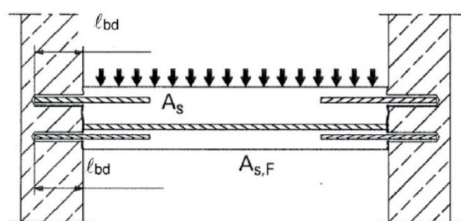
Unión solapada para conexiones de armaduras de losas y vigas.
